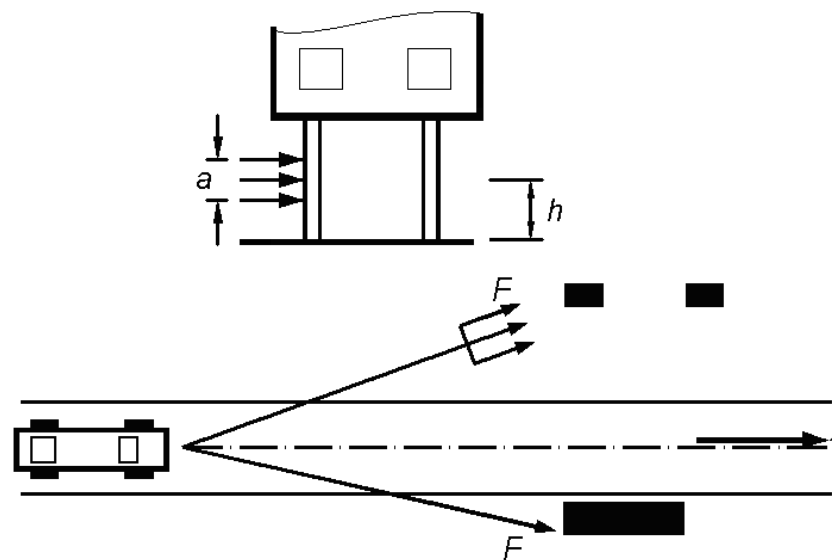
Сила від зіткнення з опорними конструкціями будівель
